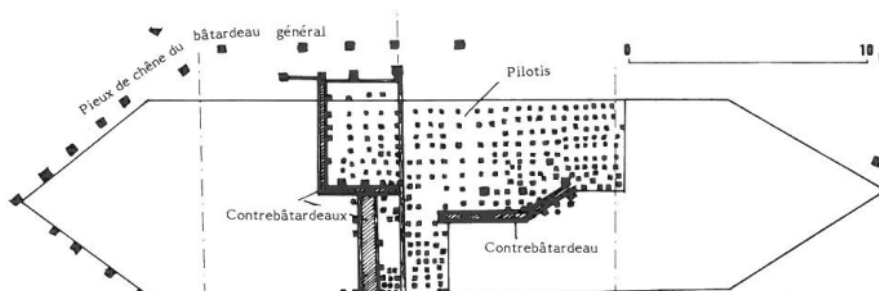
Plan de la 4^{ème} pile du pont de Toulouse ([Mesqui, 1986](#))
